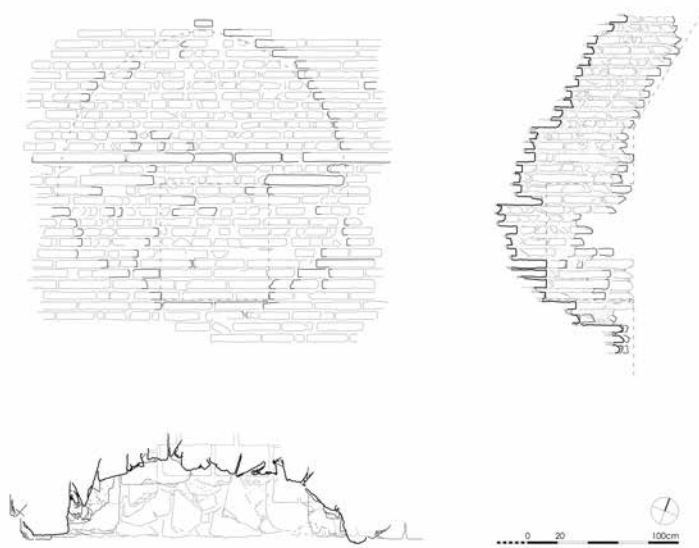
Pergamon, Rote Halle. Südwand, Bauaufnahme des zerstörten Maenianum und des Balkennests für das Pultdach der Nordhalle in Grundriss, Schnitt und Ansicht (M. 1 : 50)
